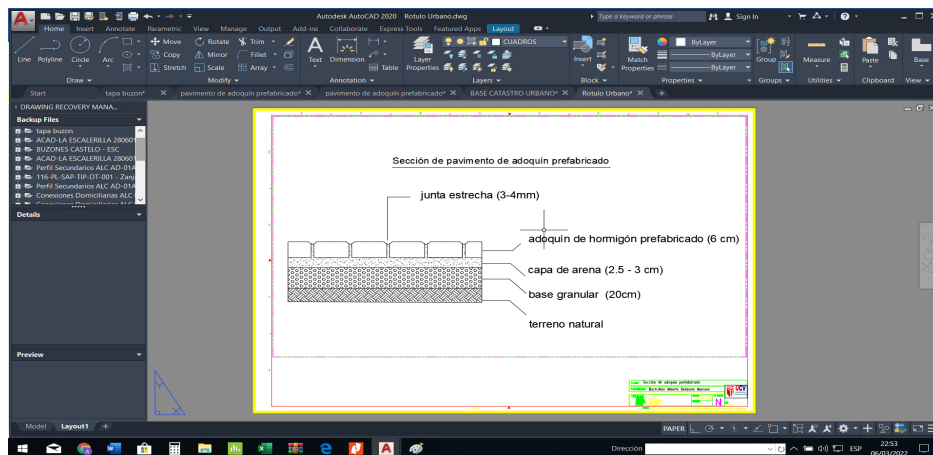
Dibujo en AutoCAD de Sección de Pavimento de Adoquines
